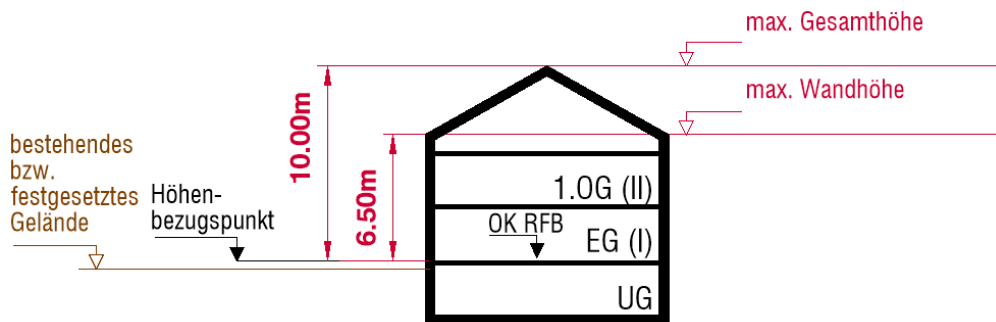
Beispielhafte Systemskizze für ein Gebäude mit Sattel- oder Walmdach im WA 1, o. M.
